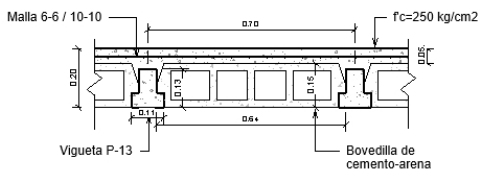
Detalle estructural de vigueta y bovedilla.
